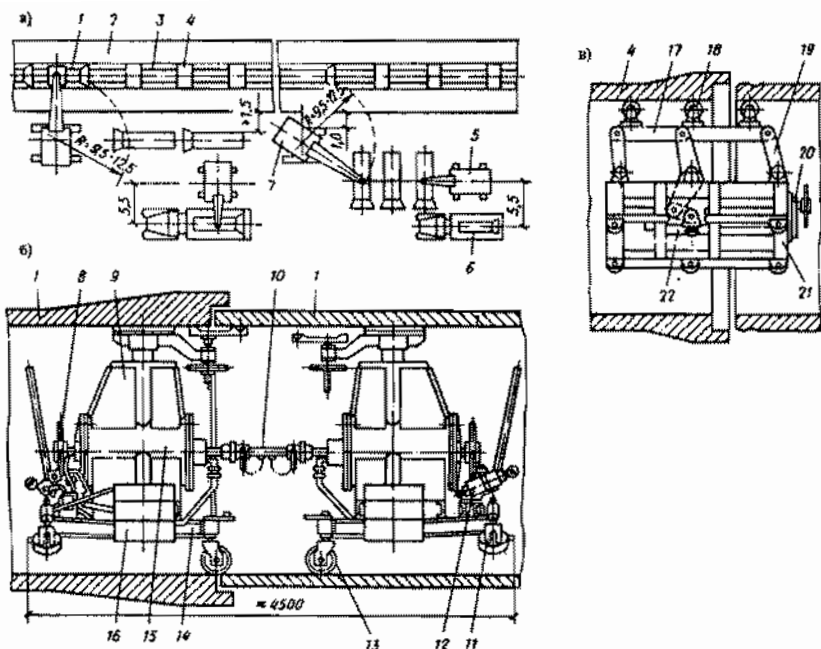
Схемы разгрузки, раскладки и подачи железобетонных труб диаметром 2000 мм в траншею (а), домкрата-стыкователя (б) и синхронизатора МВ-17 (в): 1 - труба; 2 - траншея; 3 - ложе под трубу; 4 - приямок; 5 - кран ДЭК-251; 6 - трубовоз; 7 - кран ДЭК-50; 8 - винт; 9 - корпус; 10 - тяга; 11 - поворотное колесо; 12 - гидронасос; 13 - неповоротное колесо; 14 - рама домкрата; 15 - распорно-тяговое устройство; 16 - опорная лапа; 17 - балка; 18 - ролик; 19 - стойка; 20 - механизм фиксации; 21 - рама; 22 - подвижная траверса
